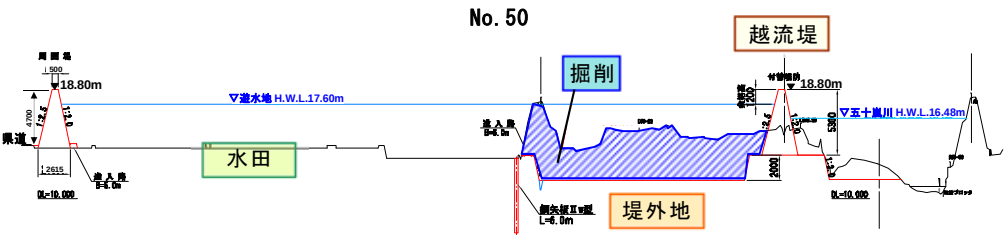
遊水地（5.6k 左岸）横断面図
